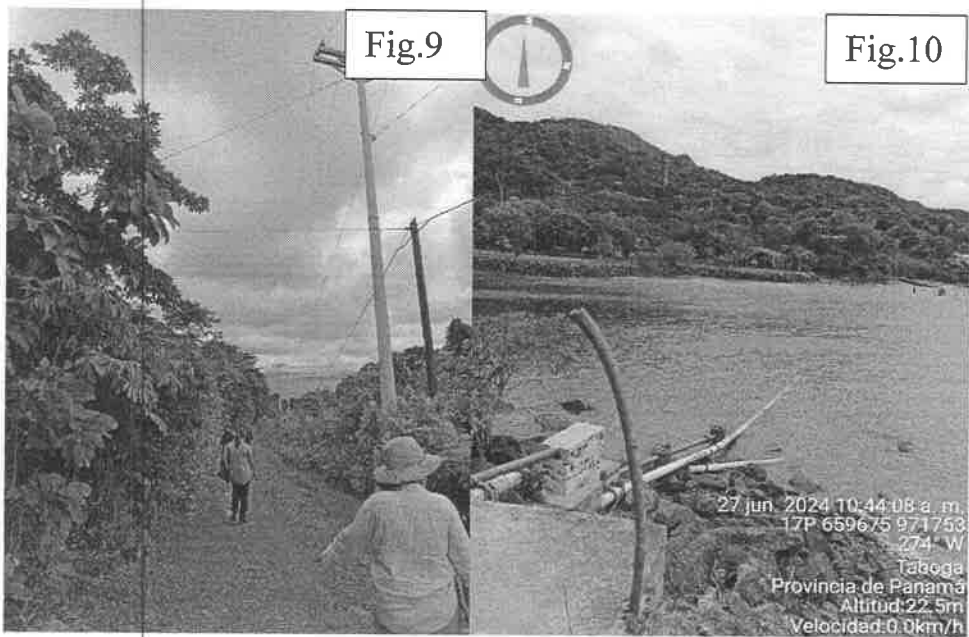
Recorrido del camino a utilizar para la instalación de las distintas líneas de tuberías, ubicadas sobre el área de servidumbre y en donde la vegetación existente que será afectada es únicamente dentro de esta zona. En las secciones donde exista terrenos de fincas privadas, las líneas de tuberías serán intercambiadas al lado opuesta, de tal manera que no se vea afectada dicha finca privada, según lo indicado en campo.
